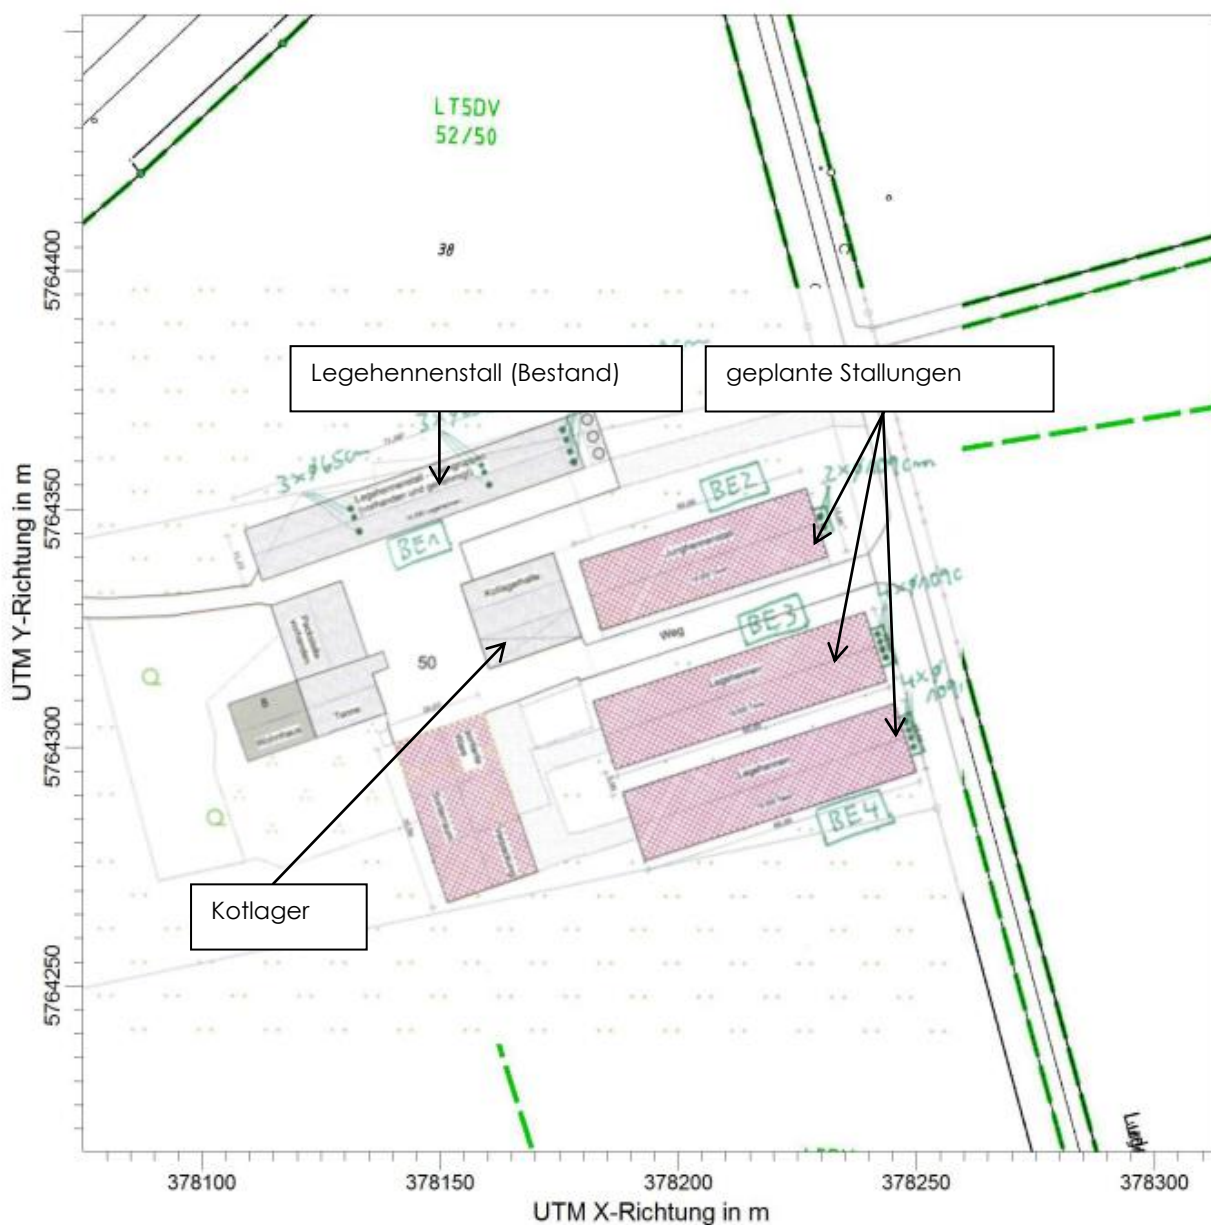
Lageplan der Hofstelle Sengenhorst
